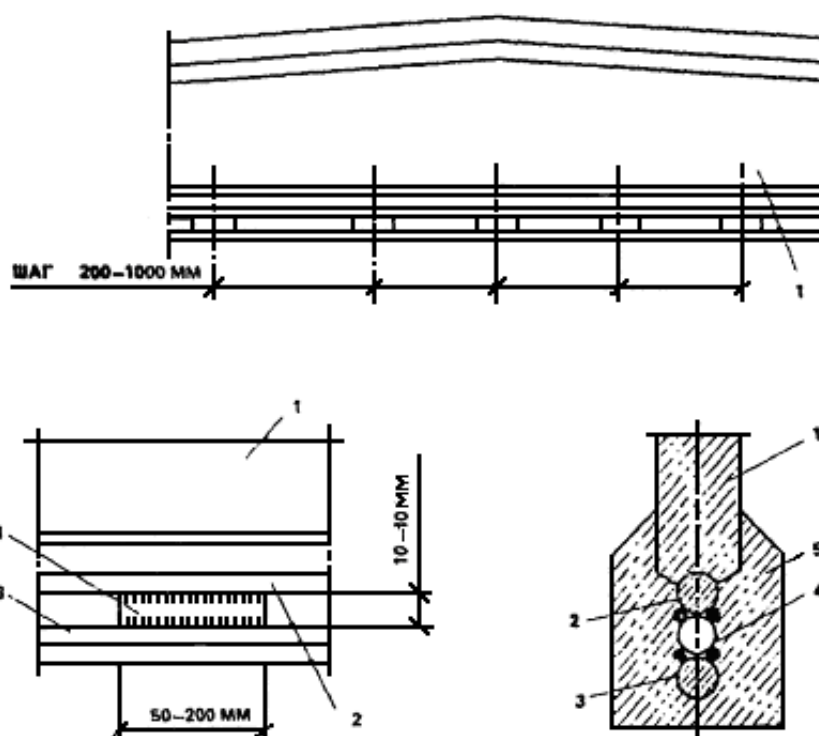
Усиление растянутой зоны балок приваркой дополнительной арматуры
